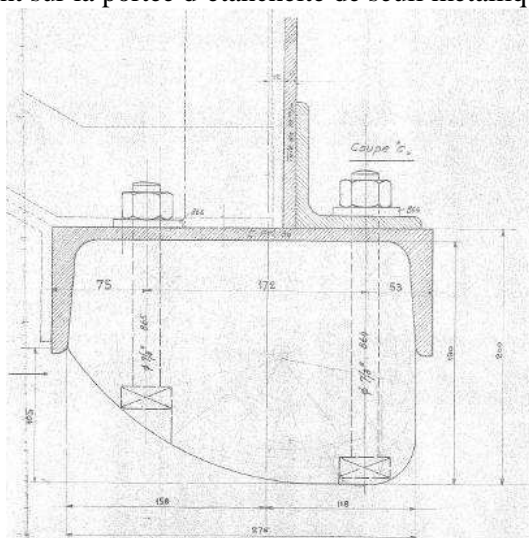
Coupe de la poutre en bois qui fait l'étanchéité de seuil
